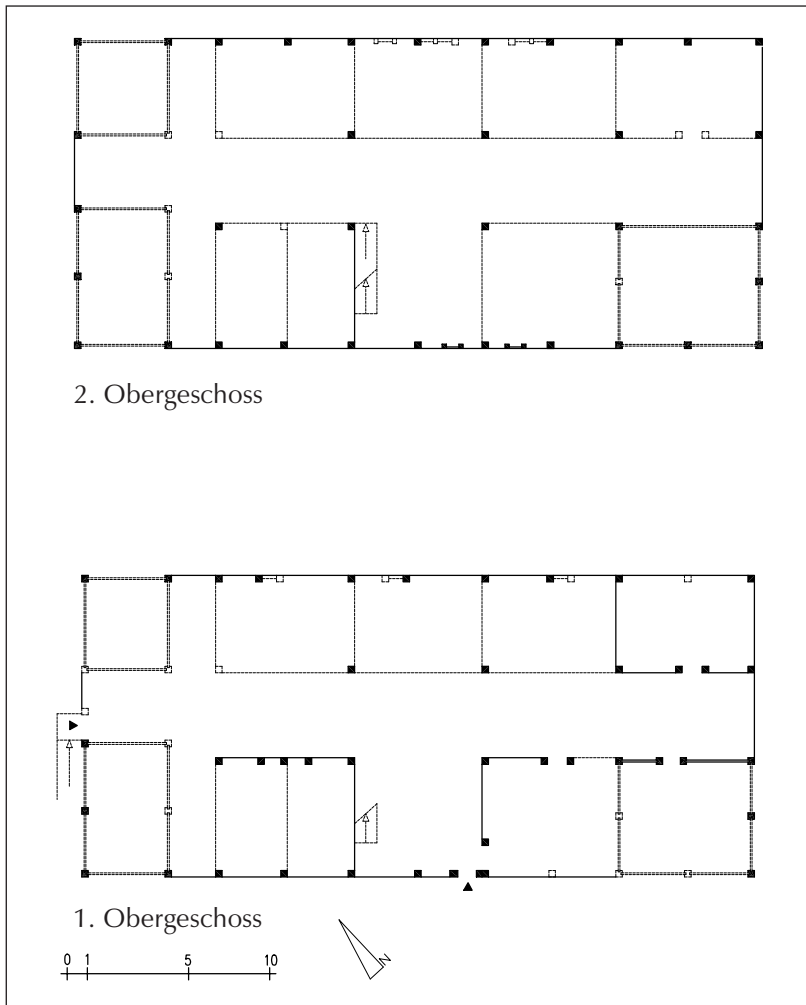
Schwäbisch Gmünd. Spital, rekonstruierte Grundrisse 1. und 2. Obergeschoss, Zustand 1434.
